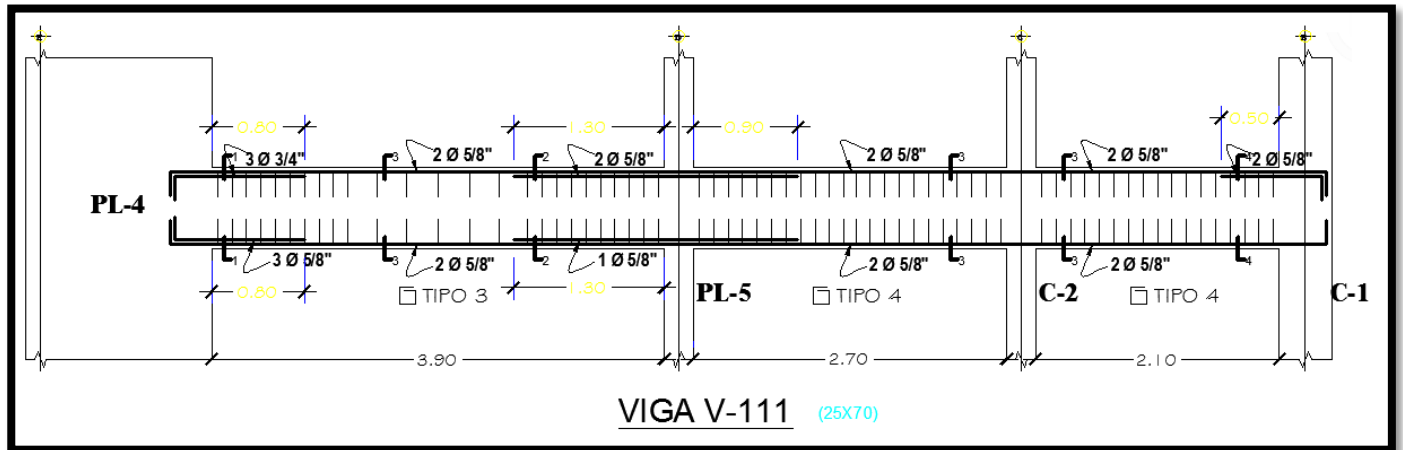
DETALLE DE VIGA V-111, V-112 Y V-113 BLOQUE B
